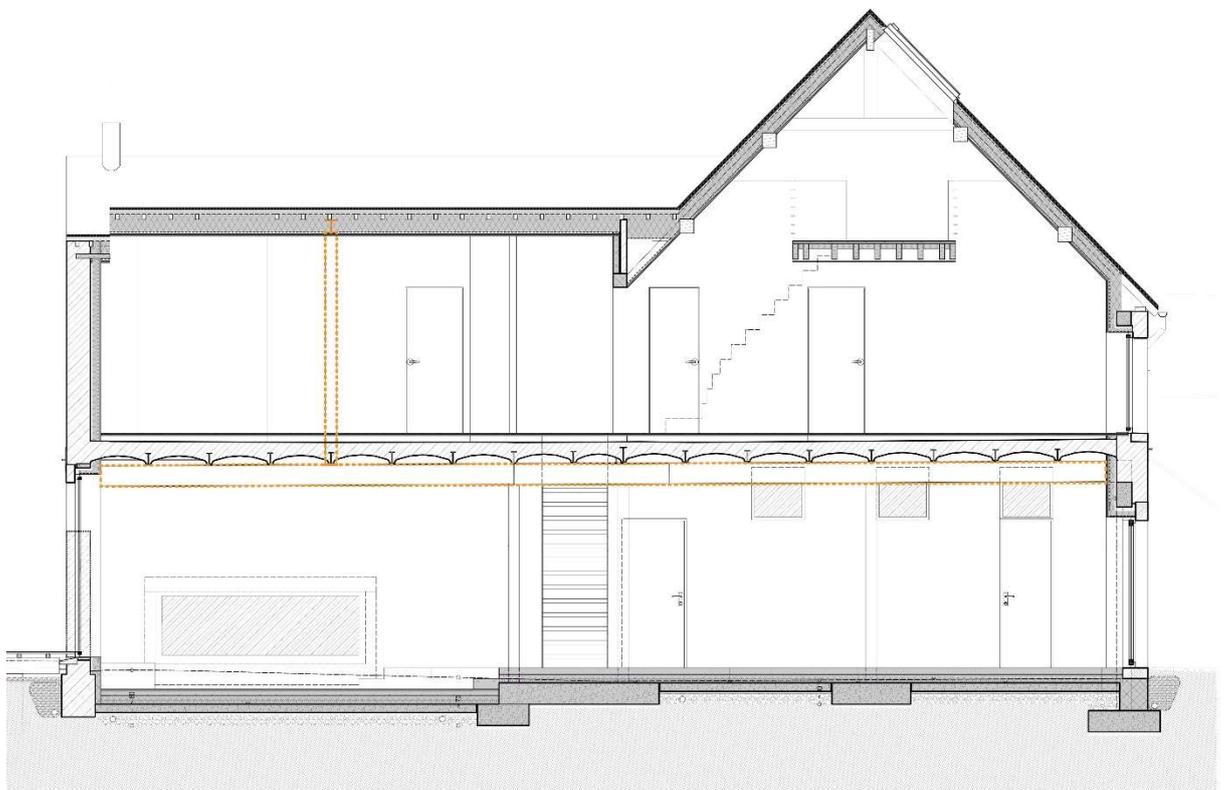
Nouvelle structure métallique et poutre soutenant les voussettes (Brogneaux, 2007)
